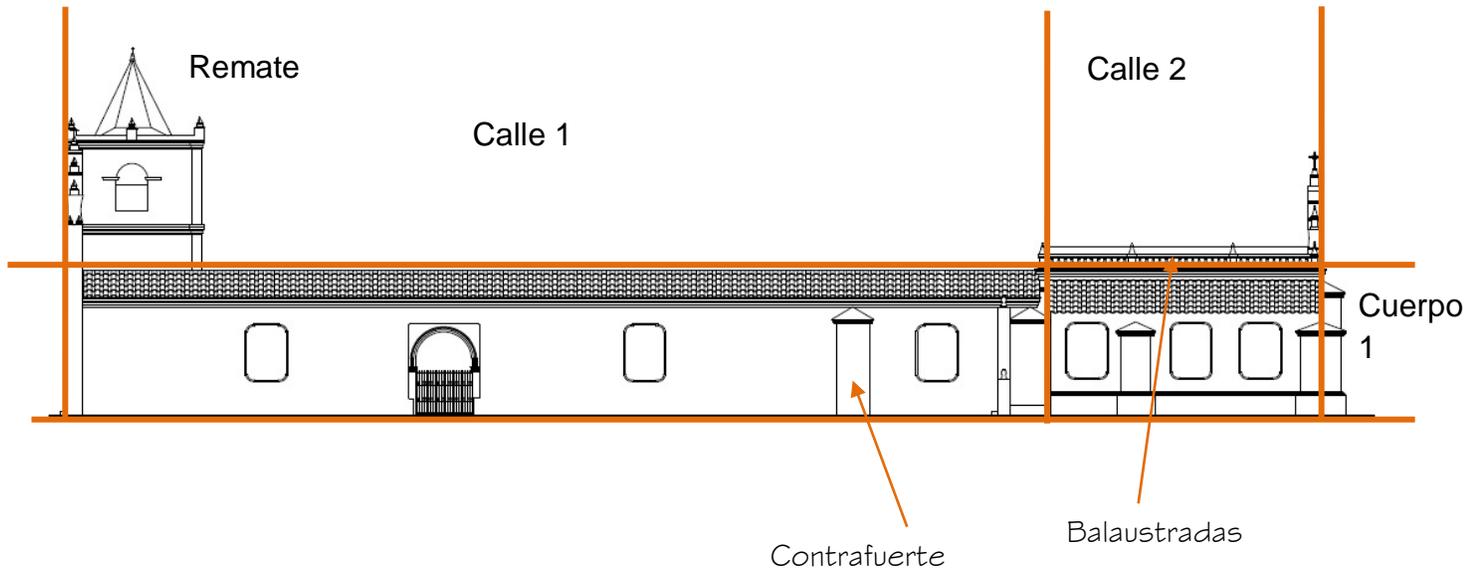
Elevación sur. Autor: Grupo de trabajo.
